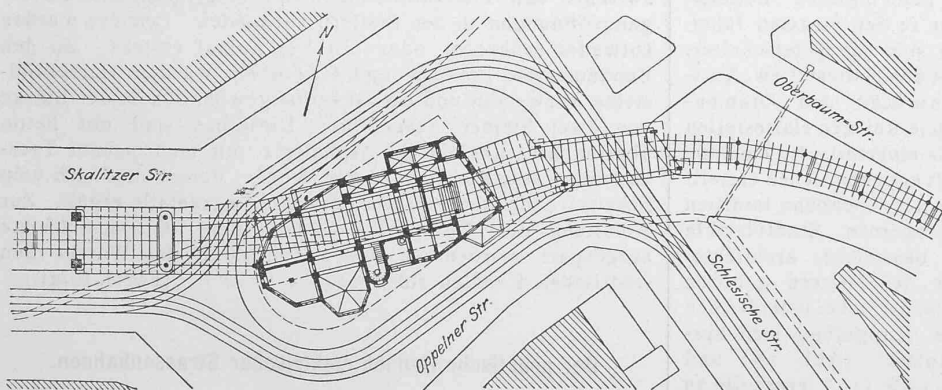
Haltestelle Schlesisches Tor. — Lageplan. Masstab 1 : 1500.
